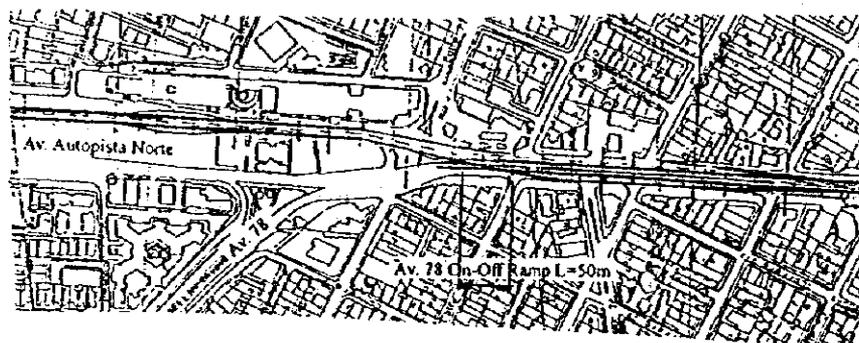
Rampa de Entrada y salida sobre Autopista Norte - Avenida 78
